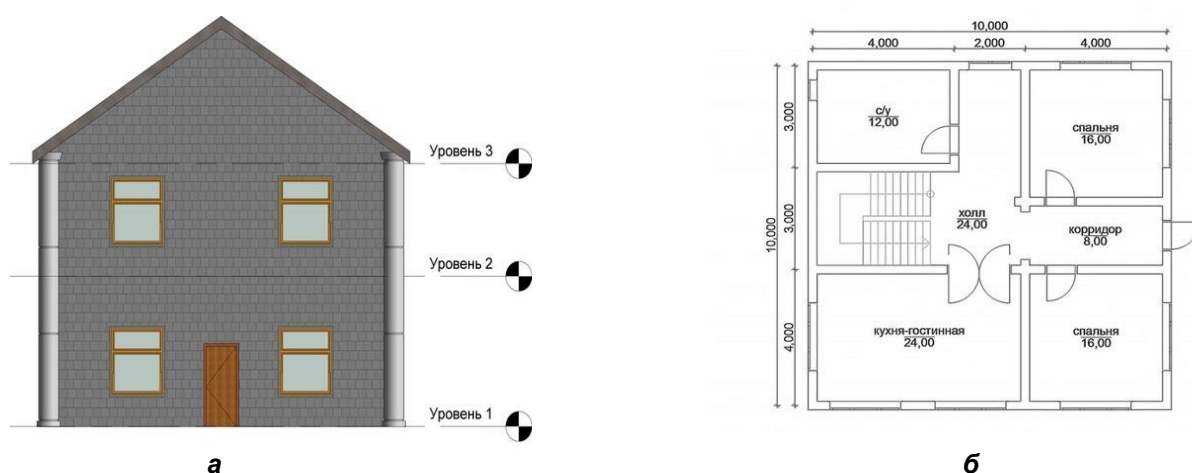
Дом из ППС-25: а – проект фасада; б – план первого этажа
